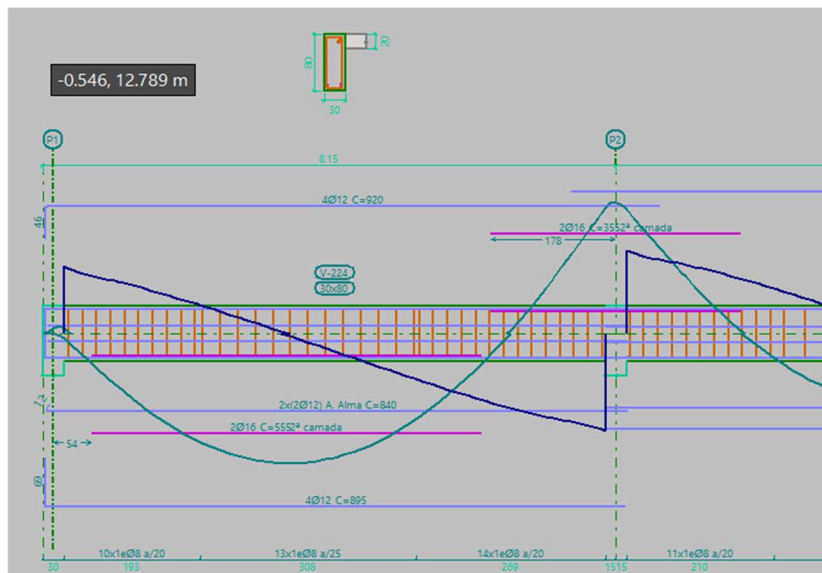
Armaduras adotadas pelo software em uma viga do modelo
